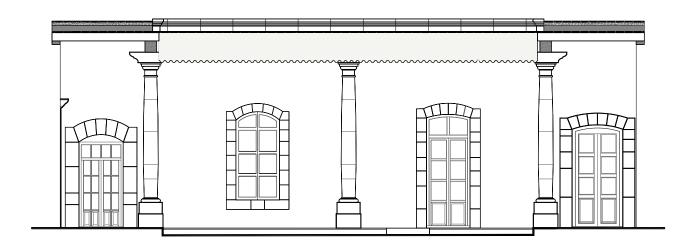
Vista del corte del corredor sur de la vivienda.
